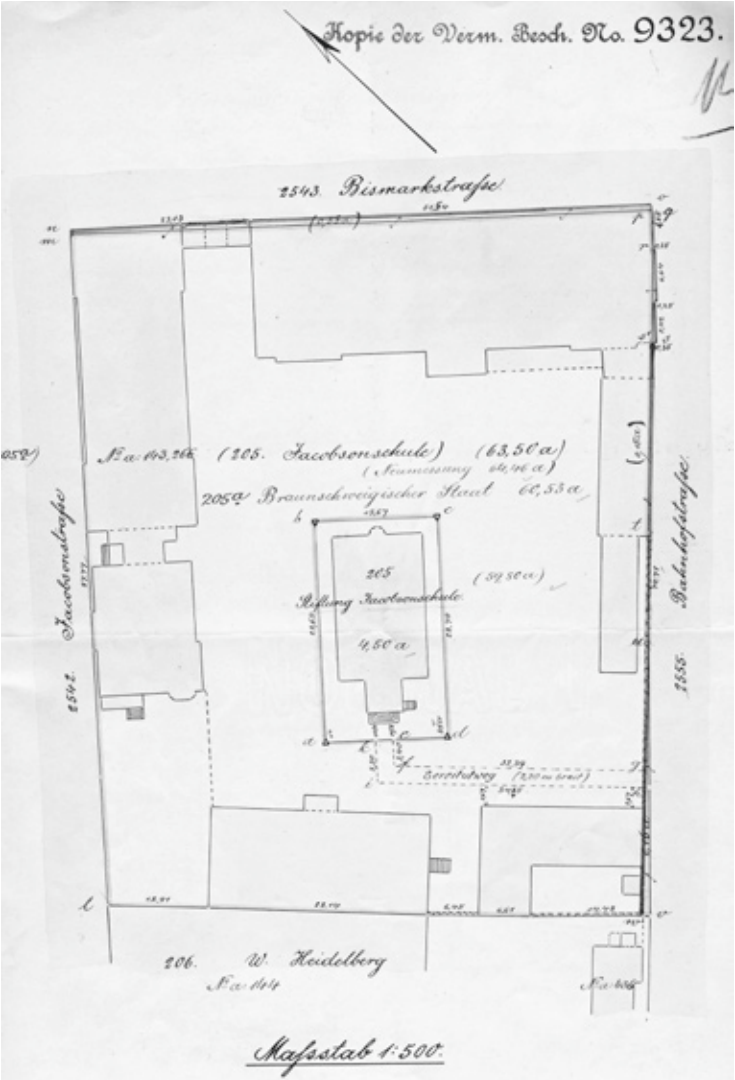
Grundrissplan der Schulanlage mit Ausweisung des Tempelgrundstücks und Servitutweg, 1922. Archiv Städtisches Museum Seesen.
